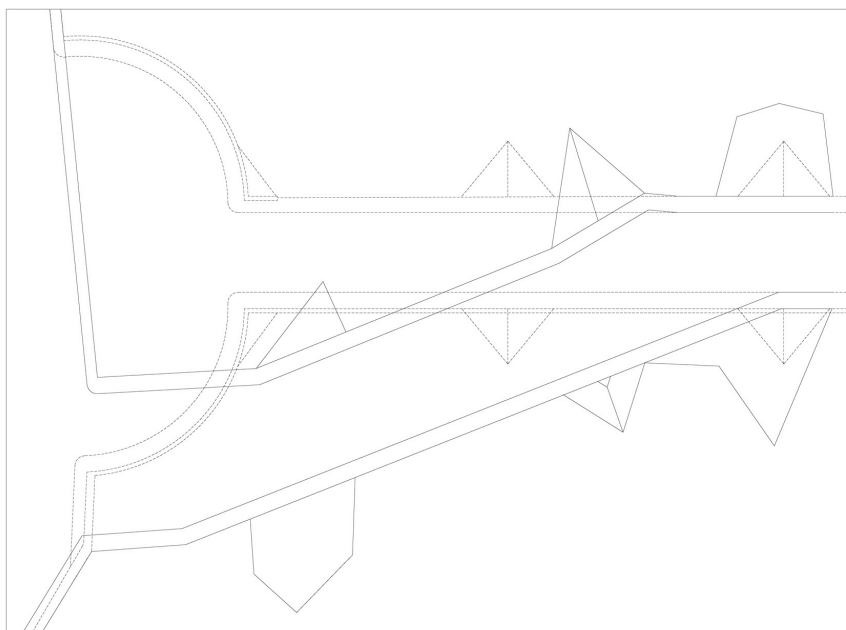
Detalle del extremo sur del puente. A trazos, la solución proyectada en la parte 11ª.
